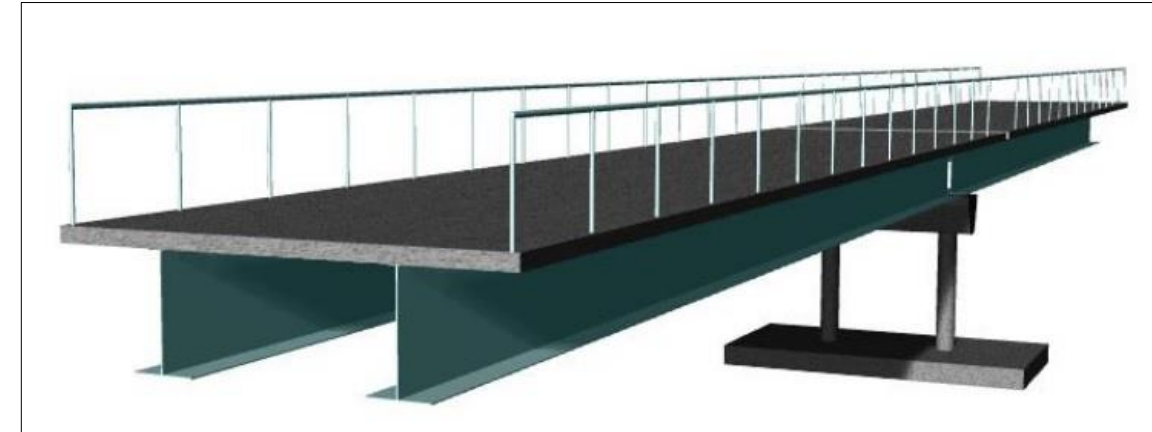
Pasarela de vigas metálicas sobre losa de hormigón. (Fuente: [http://oa.upm.es/52539/1/TFM\\_OSCAR\\_MOMPART\\_PINTO.pdf](http://oa.upm.es/52539/1/TFM_OSCAR_MOMPART_PINTO.pdf))
